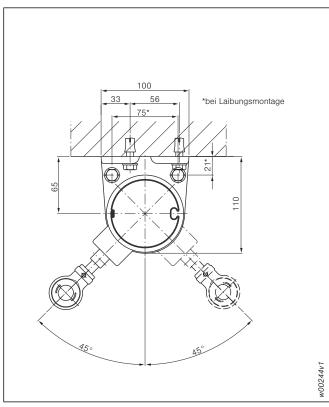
Decken- und Laibungsmontage mit außenliegendem Kurbelantrieb
